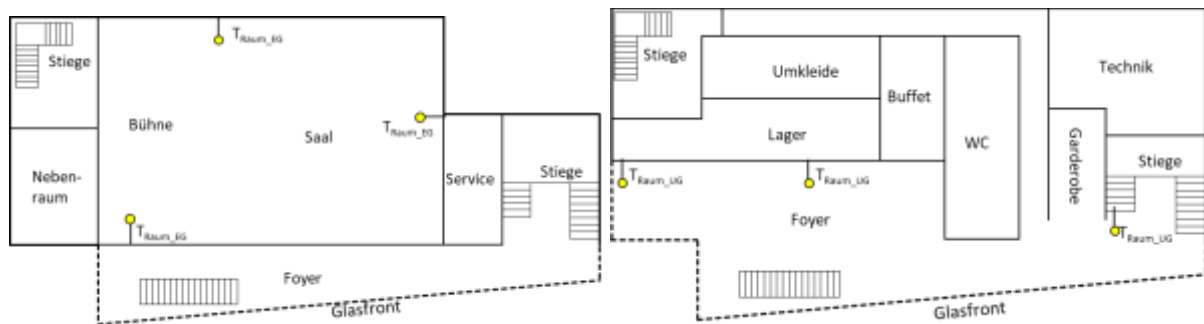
Grundriss und Position der Raumtemperaturfühler im Erdgeschoss (links) und Untergeschoss (rechts) (Quelle: Einreichplan, eigene Darstellung)
